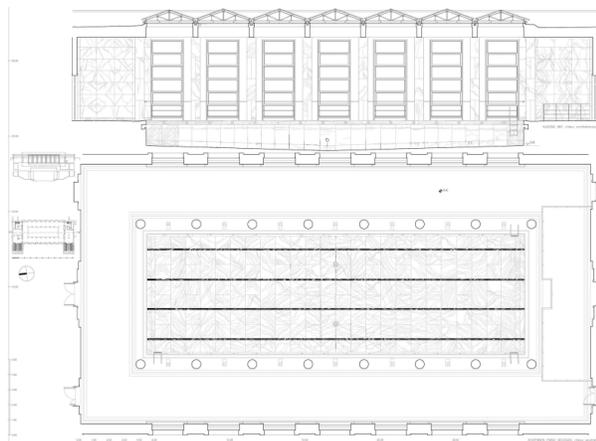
Levantamento arquitetônico da Piscina Pênsil, planta e perfil longitudinal.
